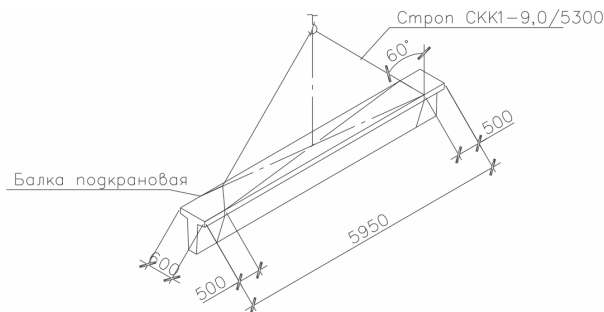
Схема строповки подкрановой балки ПБ-1
